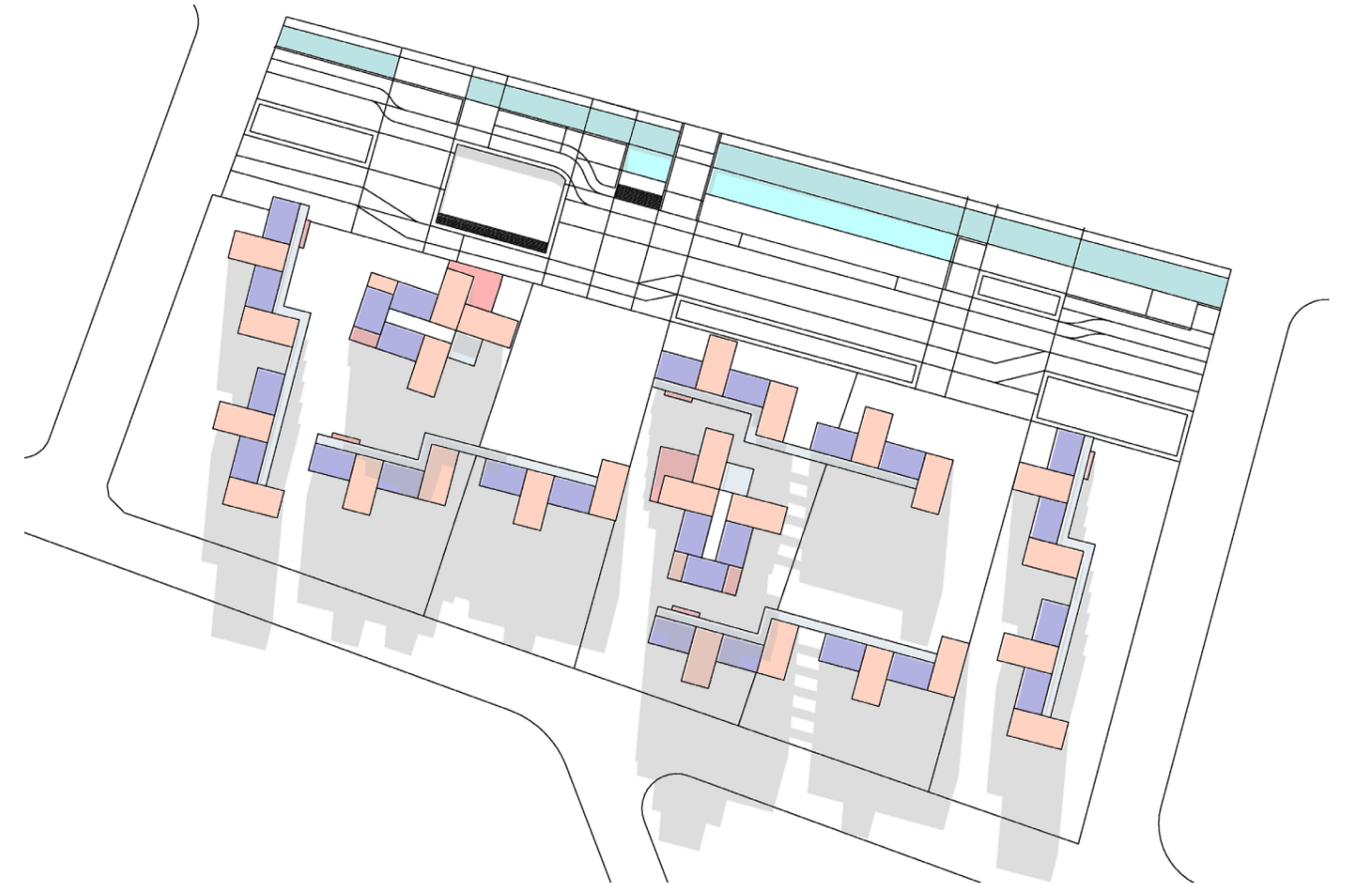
Planta general de proyecto. Fuente: Elaboración propia.
